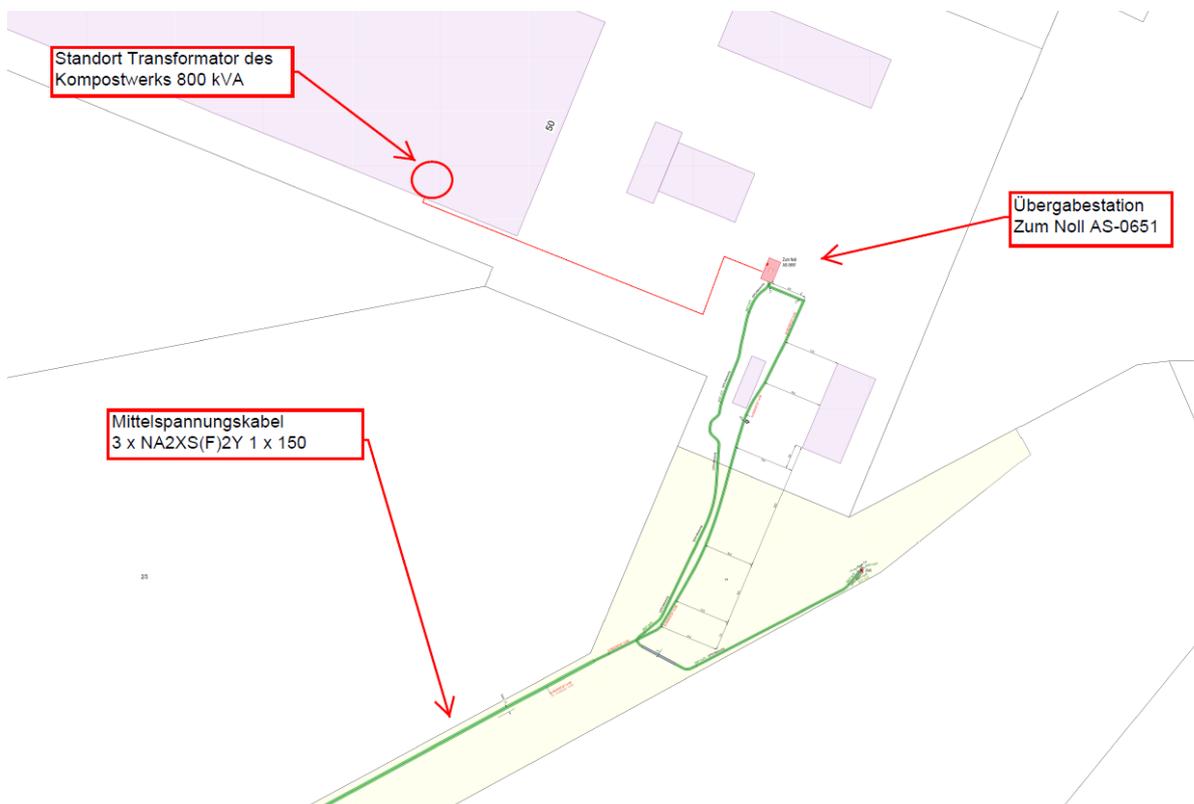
Lageplan MS-Anschluss Planauskunft Stadtwerke Gießen vom 12.07.2021
